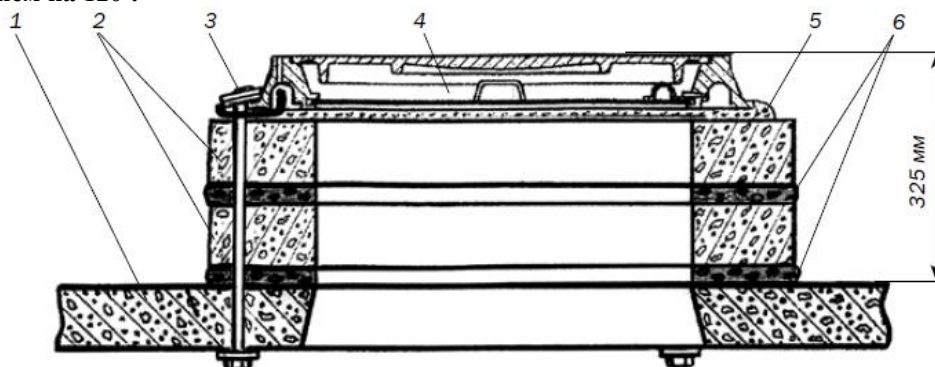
Крепление опорных колец и люка с помощью «СНКЛ-3»:
